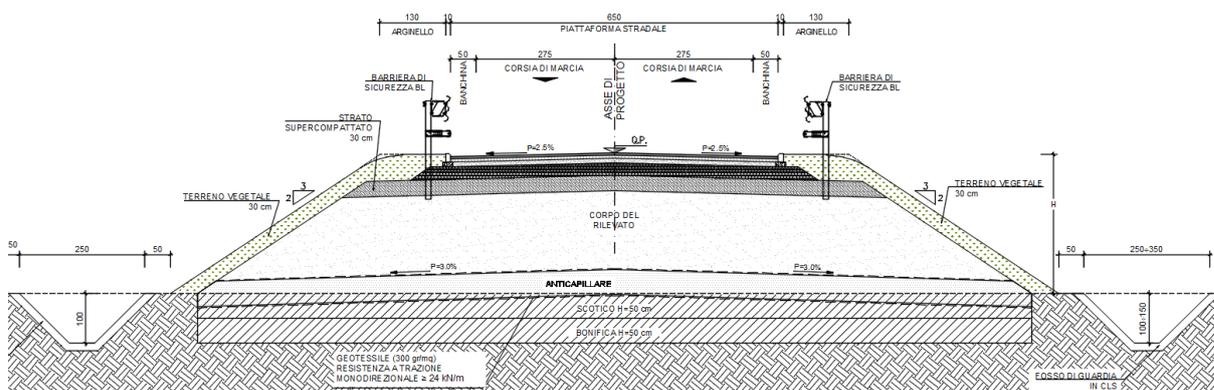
Sezione tipo in rilevato Strada F Locale Extraurbana
